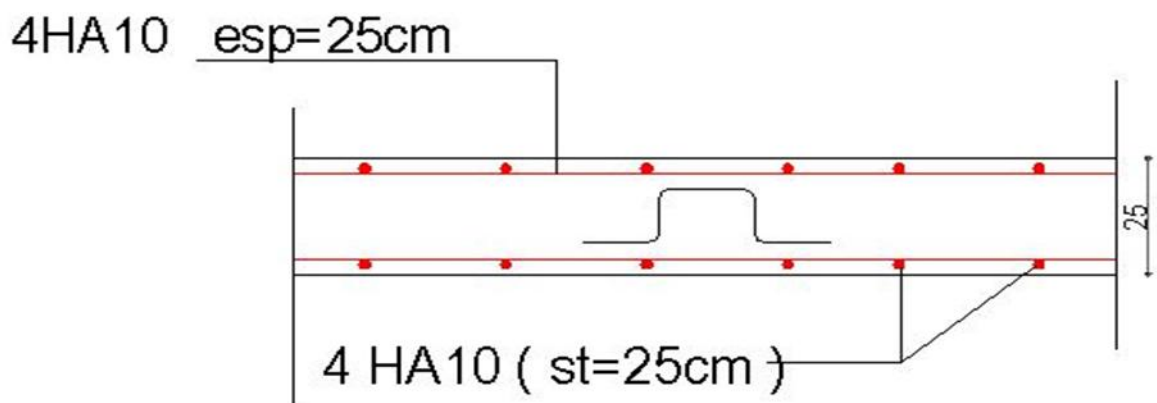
Plan de ferrailage de la salle machine suivant y-y.
